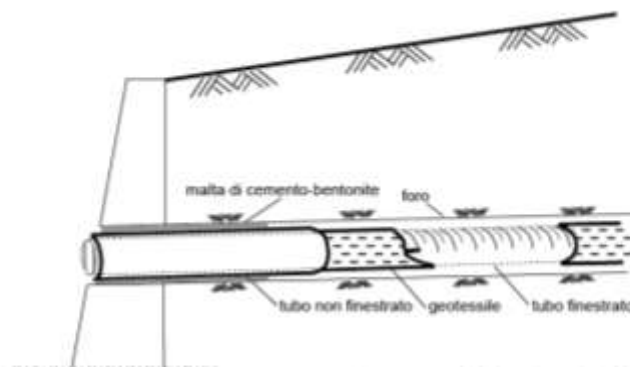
Particolare installazione al piano campagna / parete (adattata da Pun e Urciuoli, 2008)
